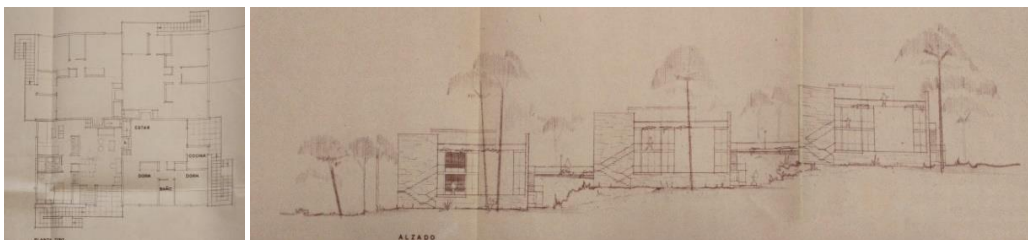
Distribució en planta baixa i en alçat dels blocs dels Apartaments Reus. Font: Bonet, A, Puig Torné, J, 1961. Arxiu COAC Barcelona.
